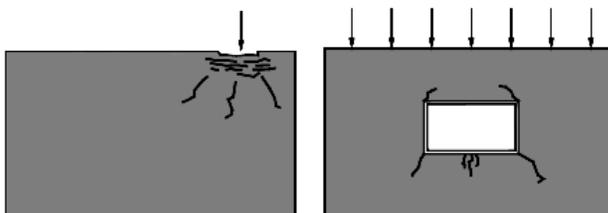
e 7: Fissuras em alvenaria por sobrecargas verticais, e por sobrecargas horizontais
